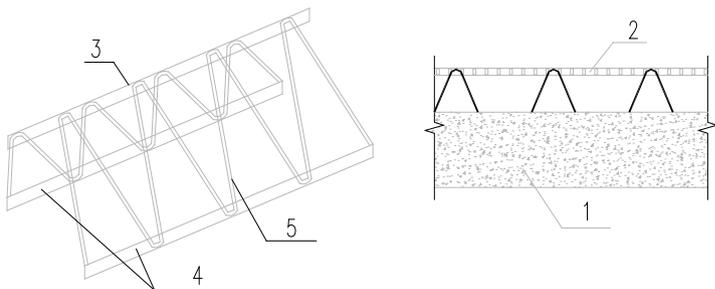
叠合板的预制板设置桁架钢筋构造示意
